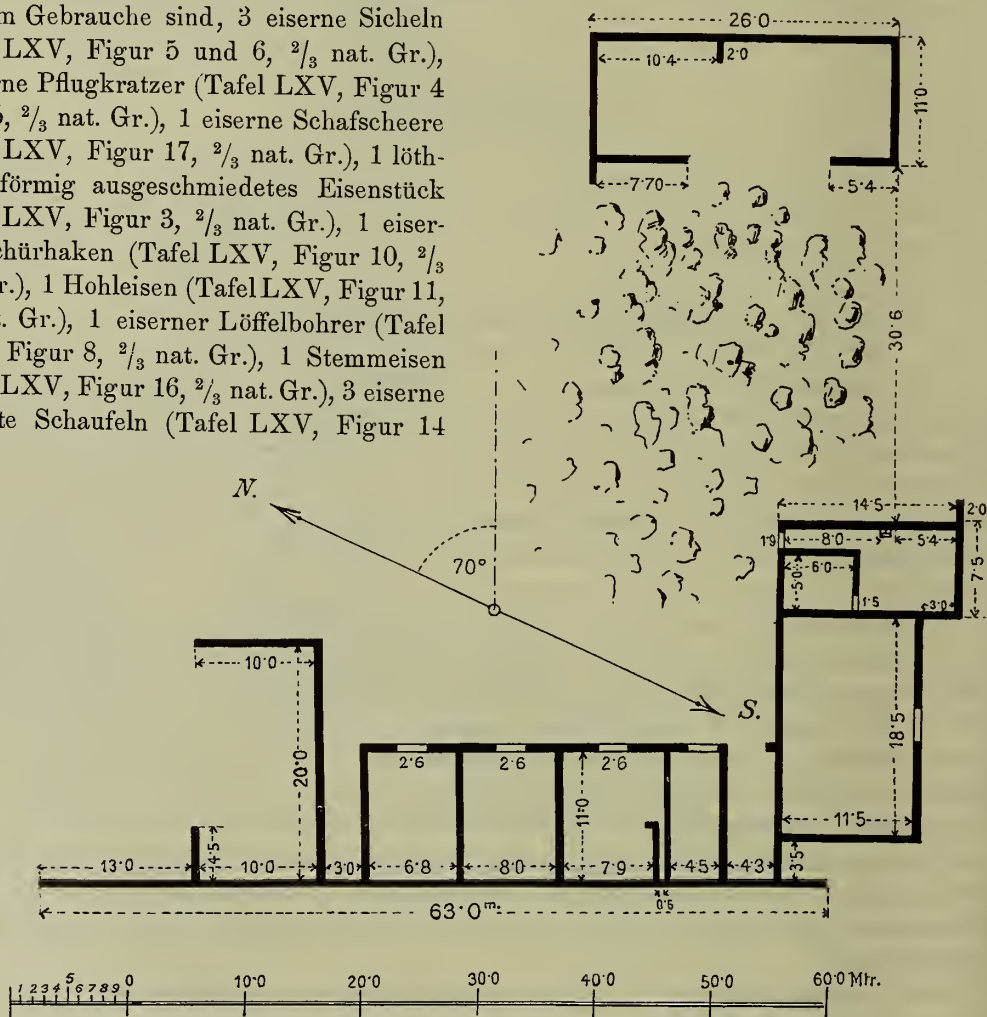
Grundriss römischer Ruinen bei Dračevica.
